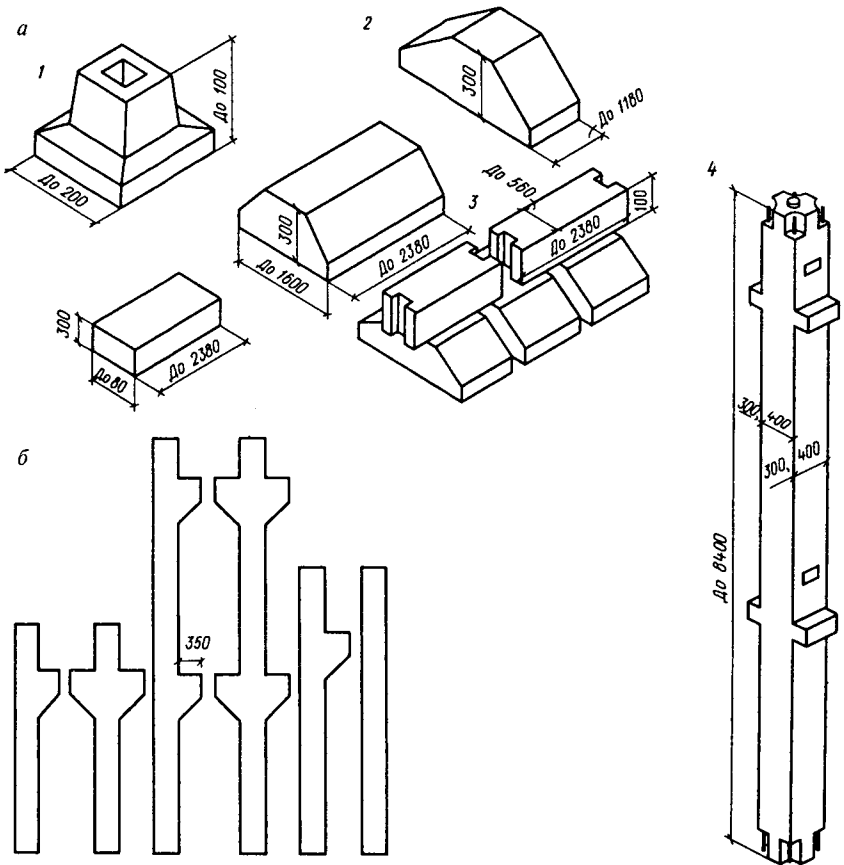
Виды фундаментных блоков (а) и колонн (б) многоэтажных промышленных зданий
